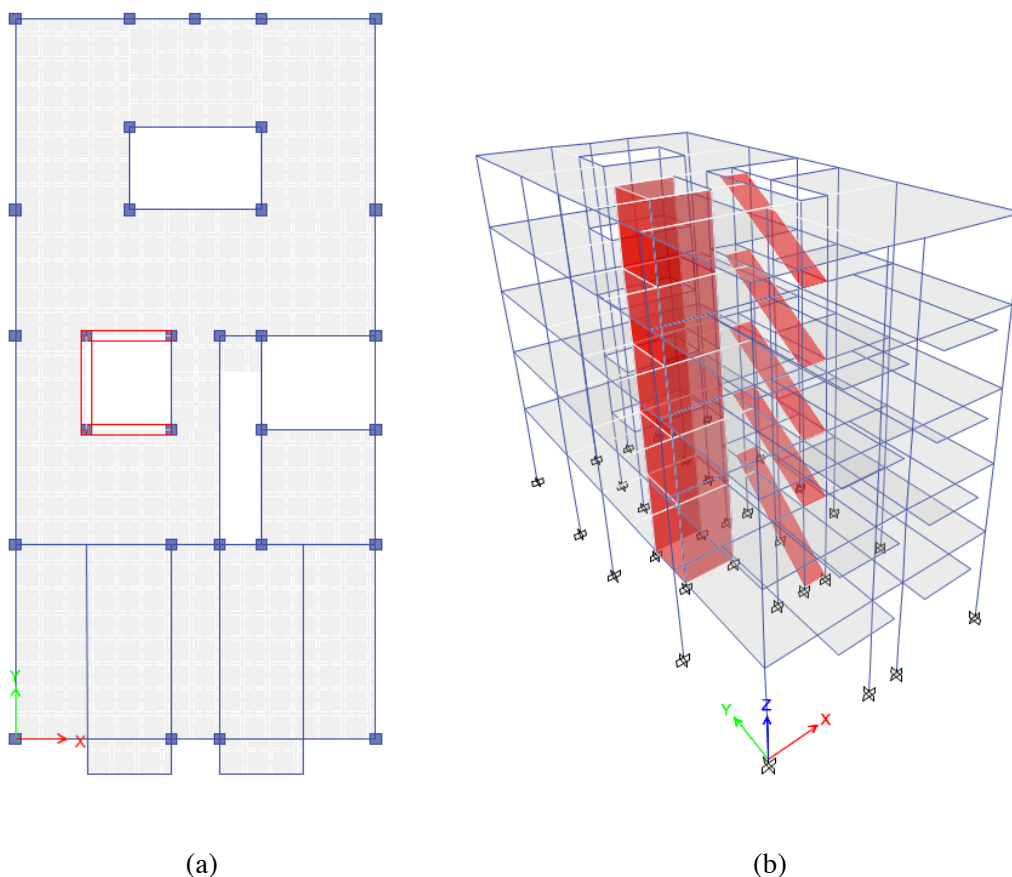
Edificio tipo 5B-S y 5B-C. (a) Planta. (b) Vista 3D
